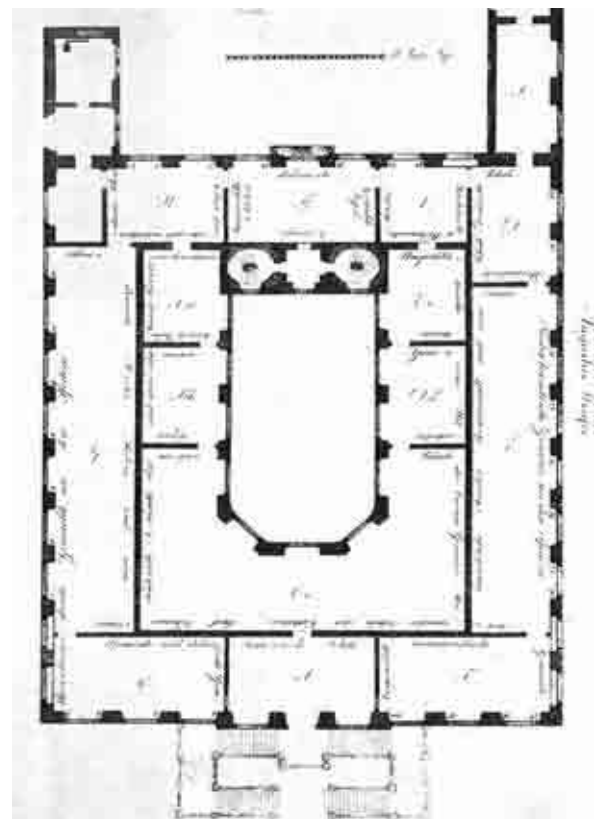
(#183) Anonymus, *Grundriss der Dresdner Gemäldegalerie*; um 1837. (Foto: TW)
